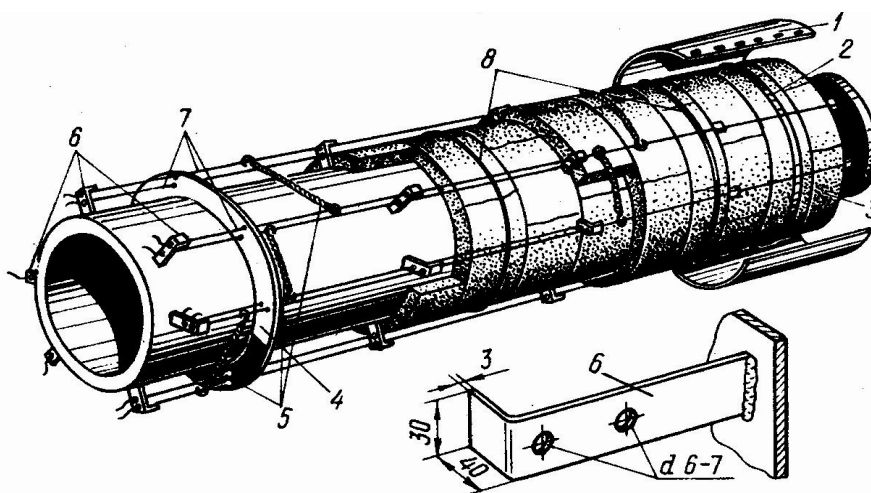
Крепление изоляционного слоя струнами на аппарате колонного типа. 1 – металлическое покрытие; 2 – бандаж; 3 – теплоизоляционные плиты; 4- опорная полка; 5- монтажный резиновый жгут; 6- опорная лапка; 7- струна (проволока Ø 6-7 мм); 8-бандаж из проволоки Ø 2мм.
